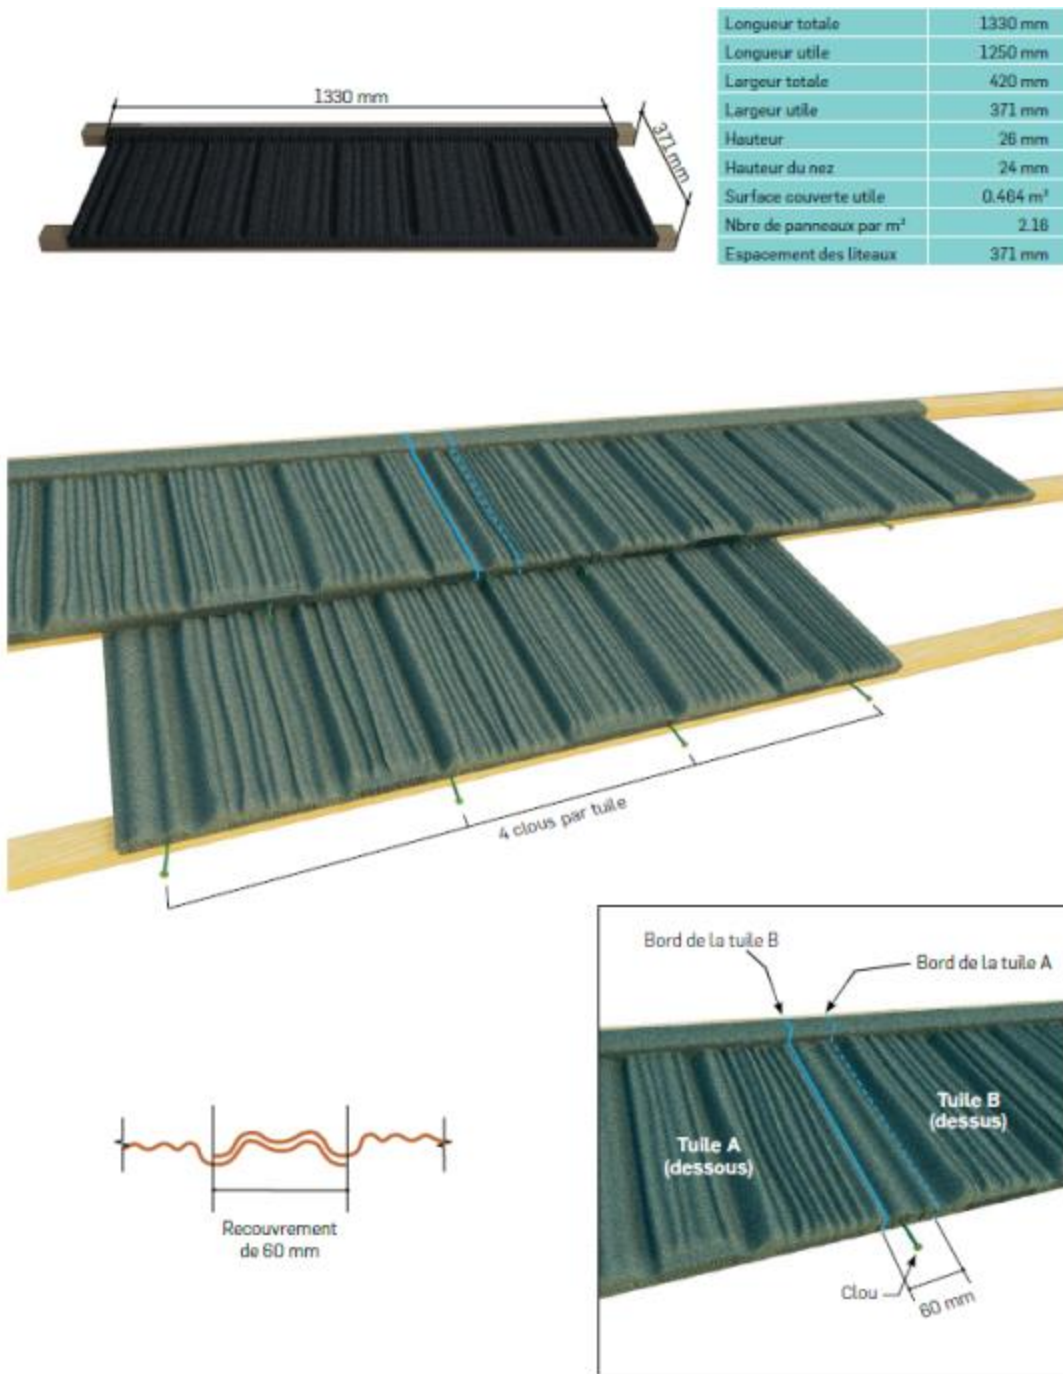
Tuile « GERARD CORONA », dimensions, clouage et recouvrement
